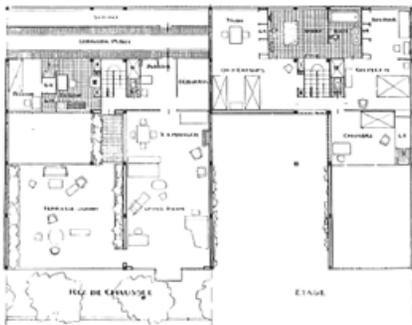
| L'Immeuble Villas, Grundriss der durchgehend gleichen Maisonette
